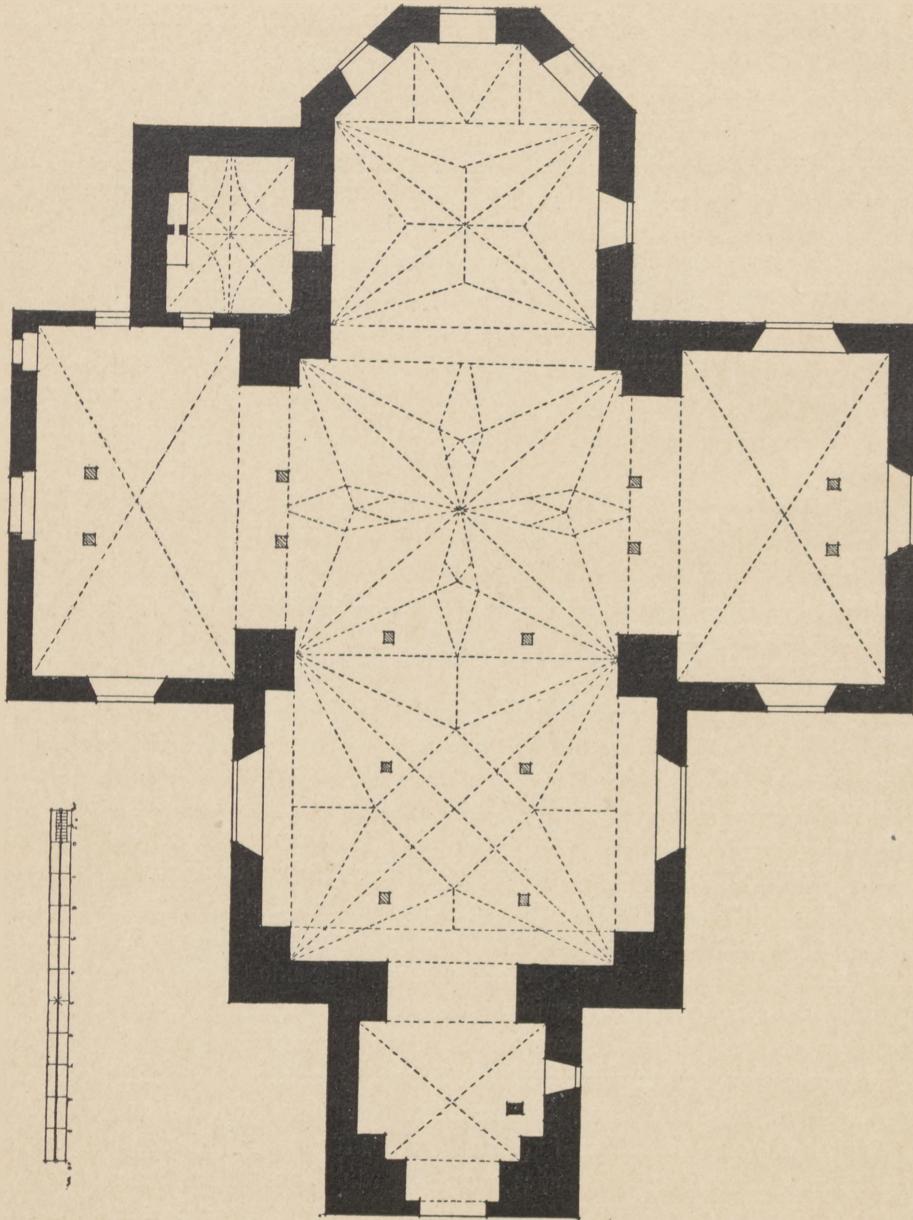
Grundriss der Kirche zu Angerburg.
